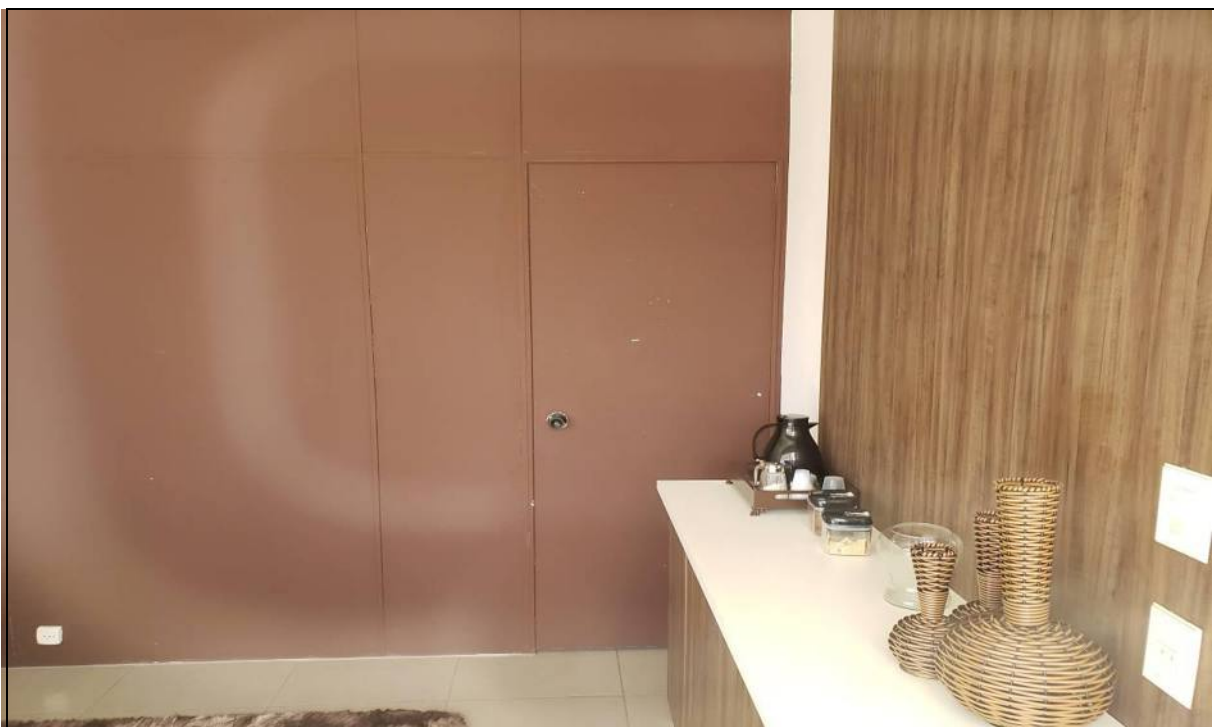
Vista interna da sala nº12 no empreendimento Center Fonte
